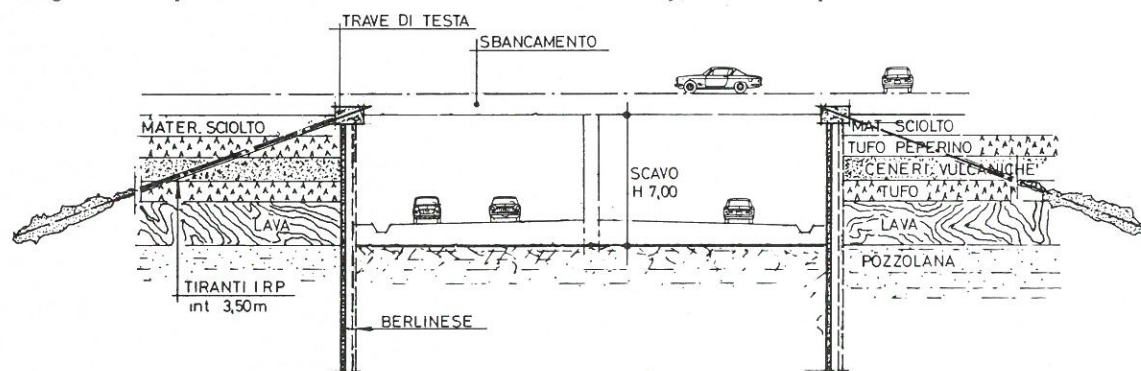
Sezione trasversale dello scavo nella zona sottopasso. La formazione di lava molto tenace ha imposto una variazione di tecnologia per il sostegno della trincea
